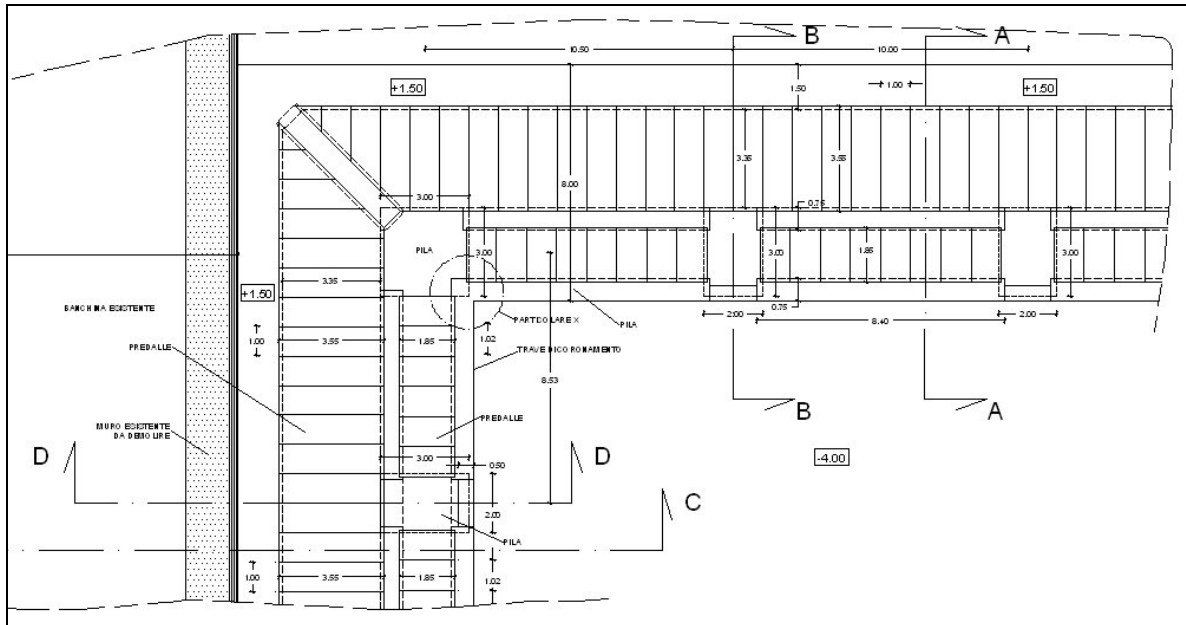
Planimetria banchina a giorno: dettaglio strutture
